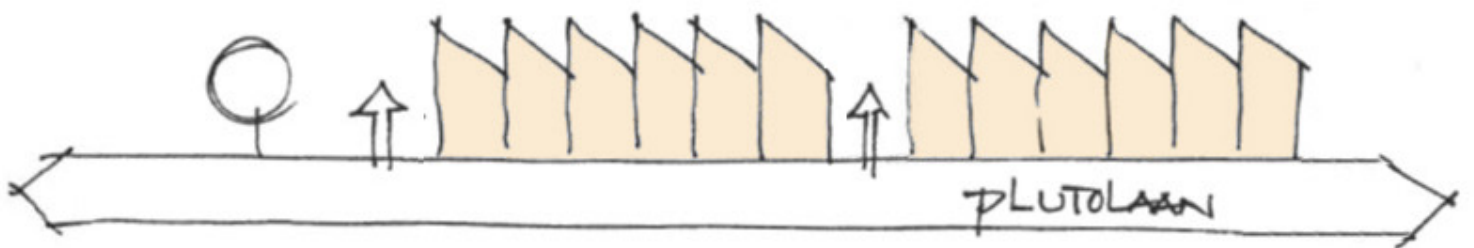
Plangebied zone D 'formeel hof-felijk'.
